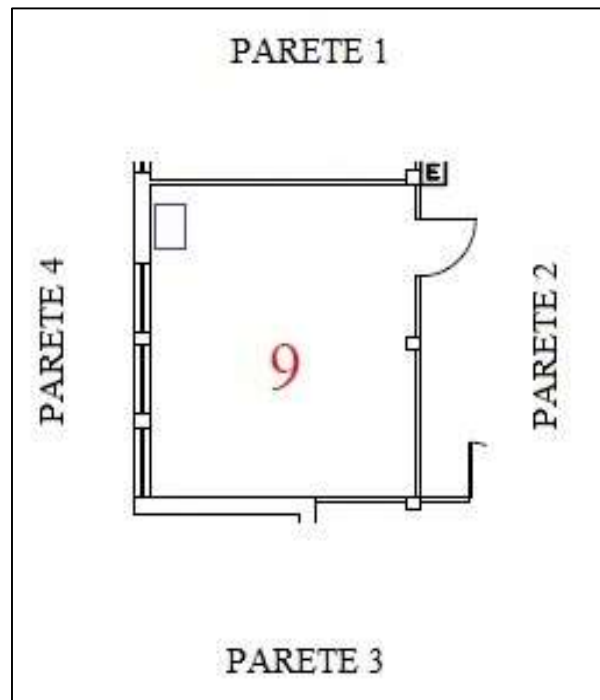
Planimetria dell’Aula 9 (1°B) oggetto di misurazioni
